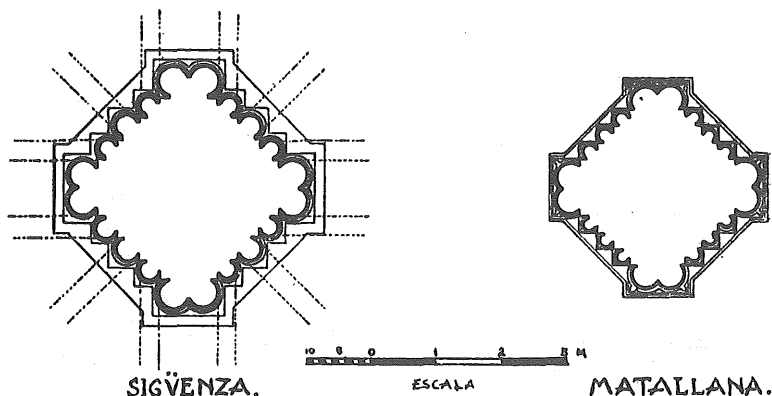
Planta de los pilares de separación de las naves de la catedral de Sigüenza (Gualajara) y de la iglesia del monasterio de Matallana (Valladolid). (Planos de L. Torres Balbás.) Escala: 1 centímetro por metro.
